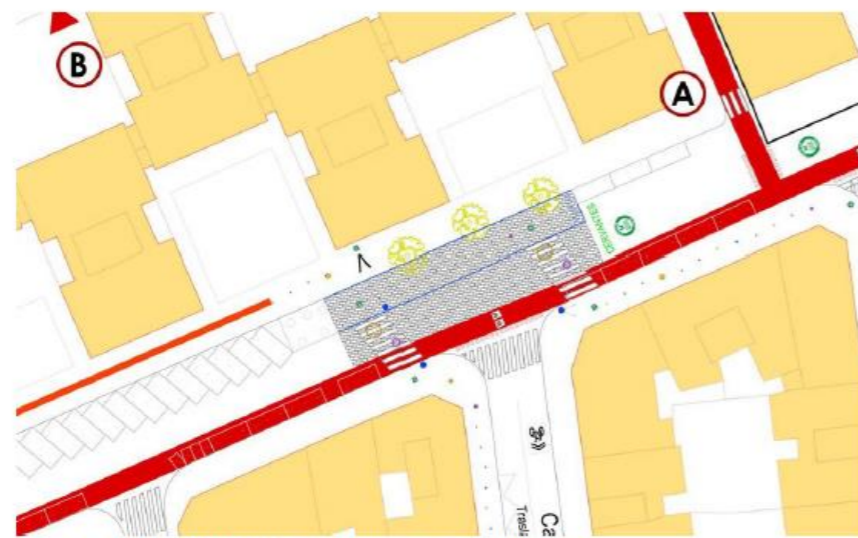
Plano detalle del EES del centro en Camino de Rubín
